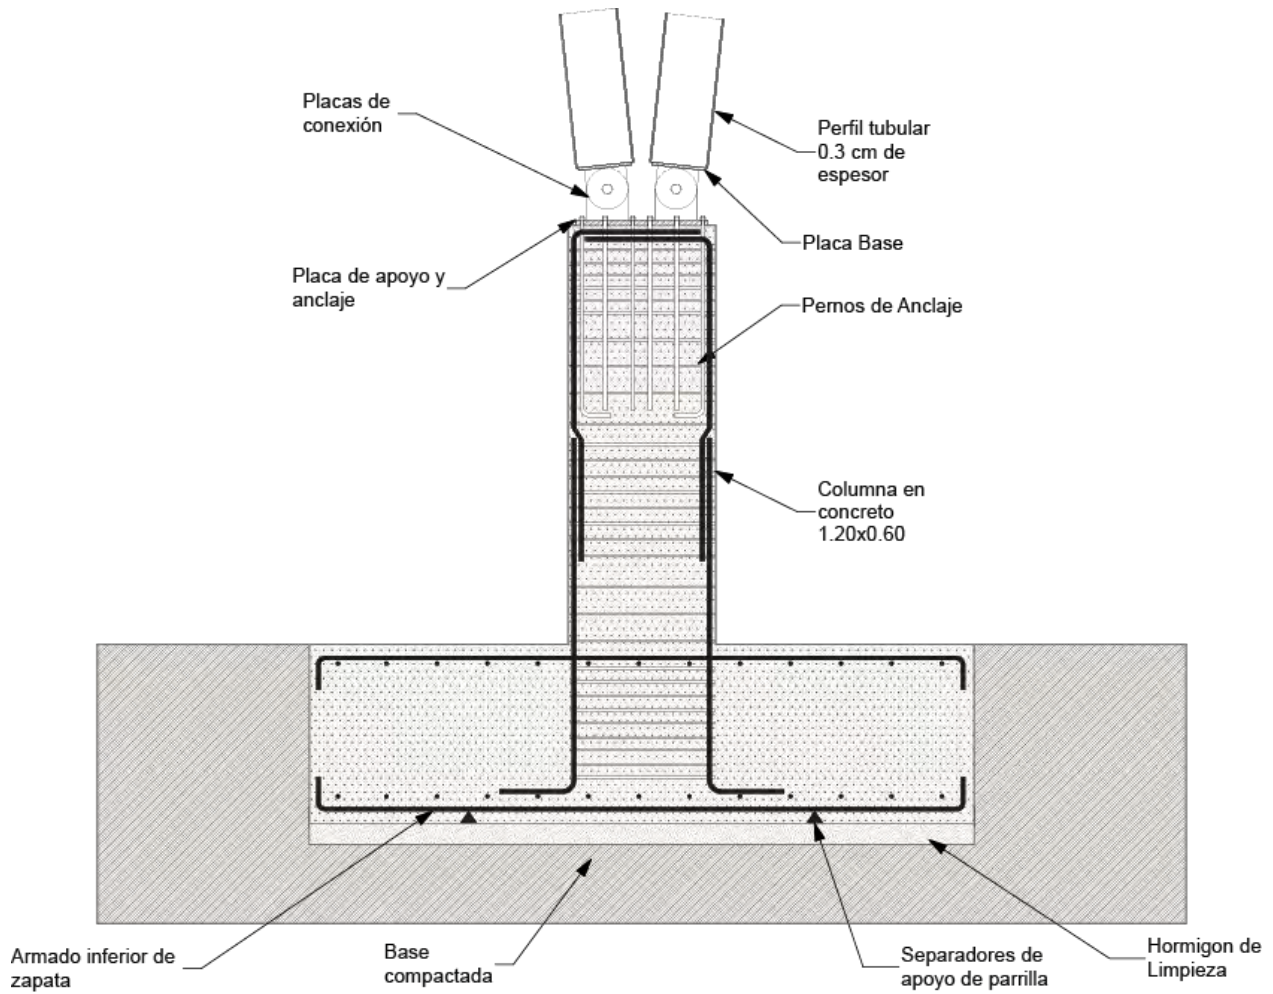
Detalle sección columna primer piso Bloque B (Auditorio). Fuente: Elaboración Propia.
